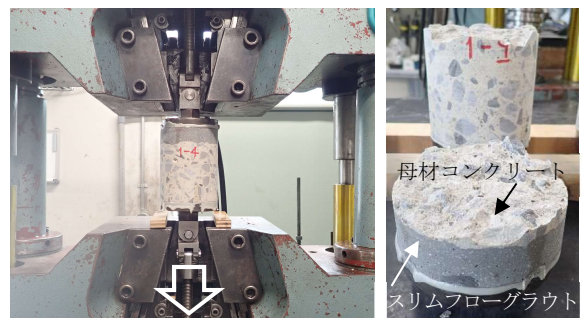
直接引張性試験の状況(左)と破壊状況(右)
